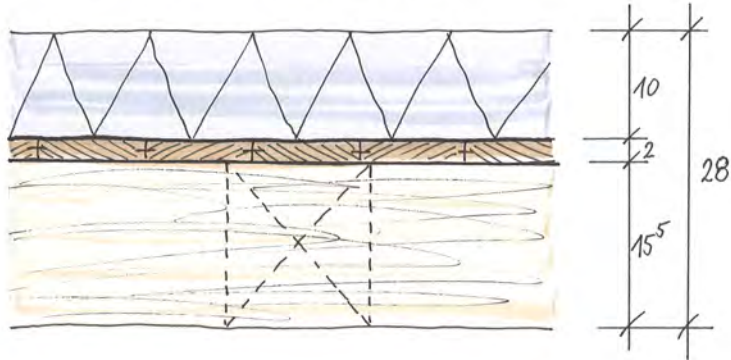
Deckenaufbau 1 Obergeschoss Gang
